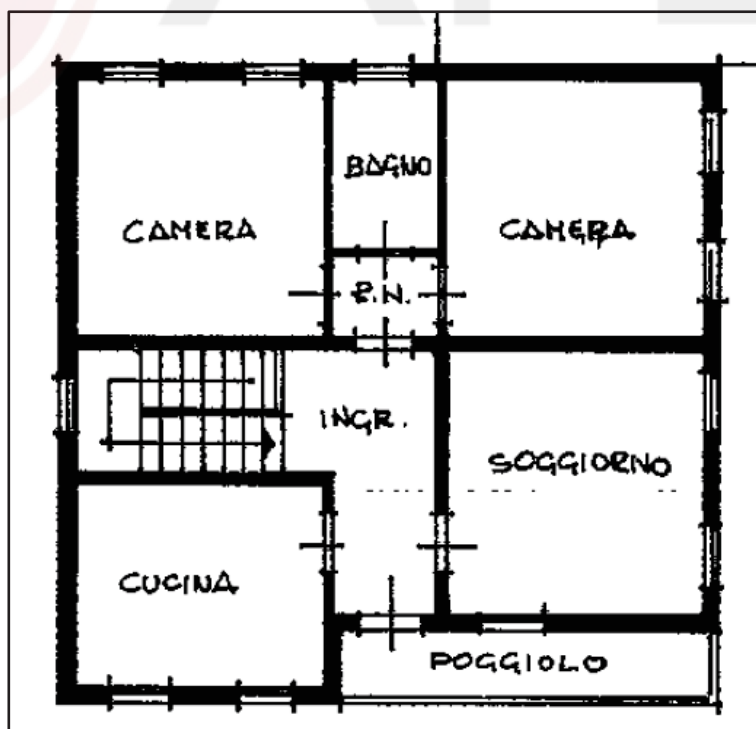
Pianta del primo piano (tratta dalla planimetria catastale)
